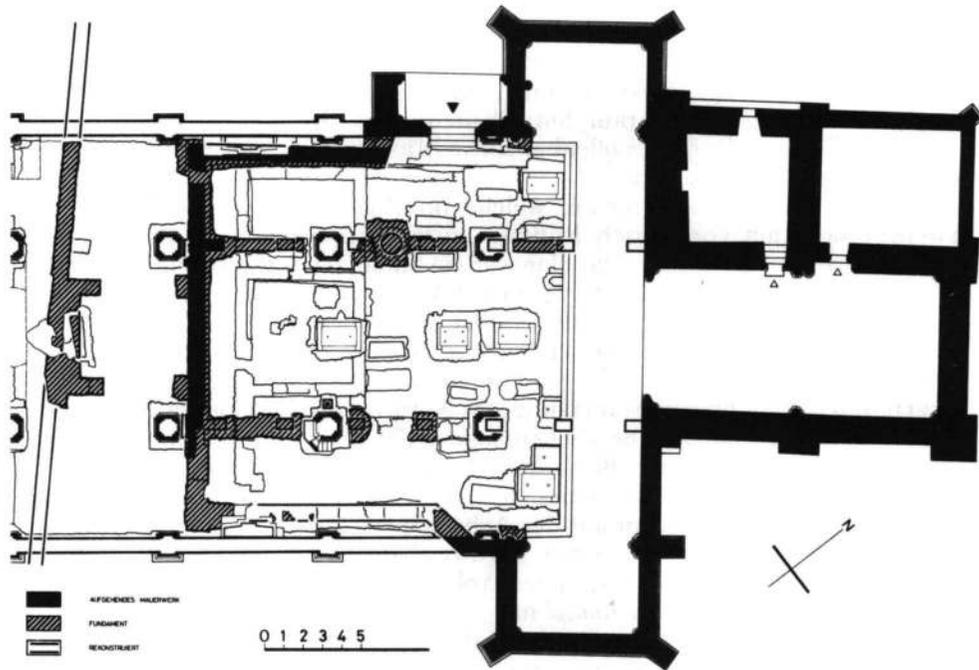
Anlage V: rekonstruierter Grundriss (Massstab 1 : 400).
